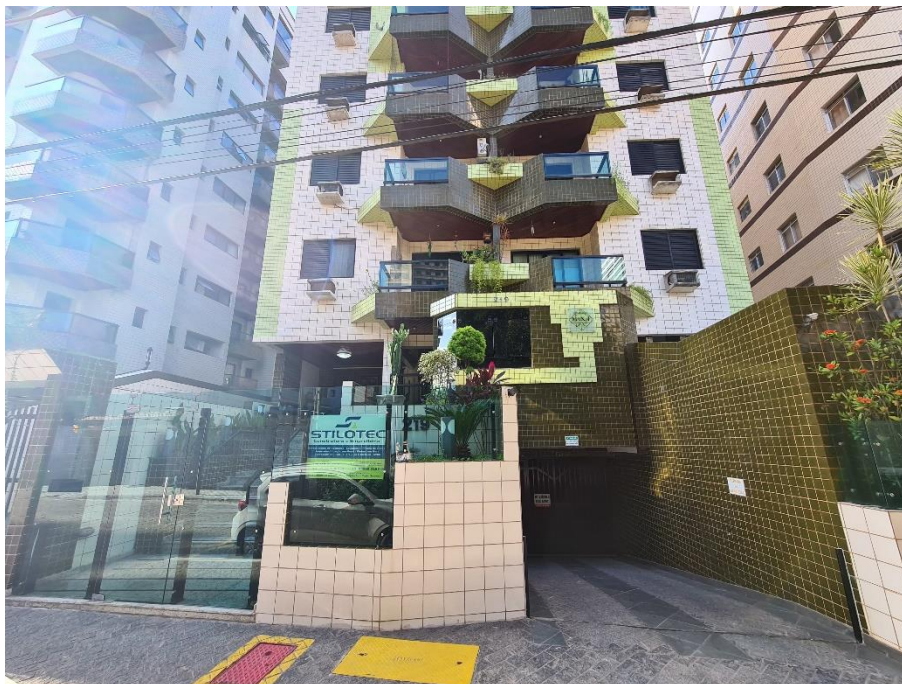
Vista da fachada do Edifício Residencial Max IV.
